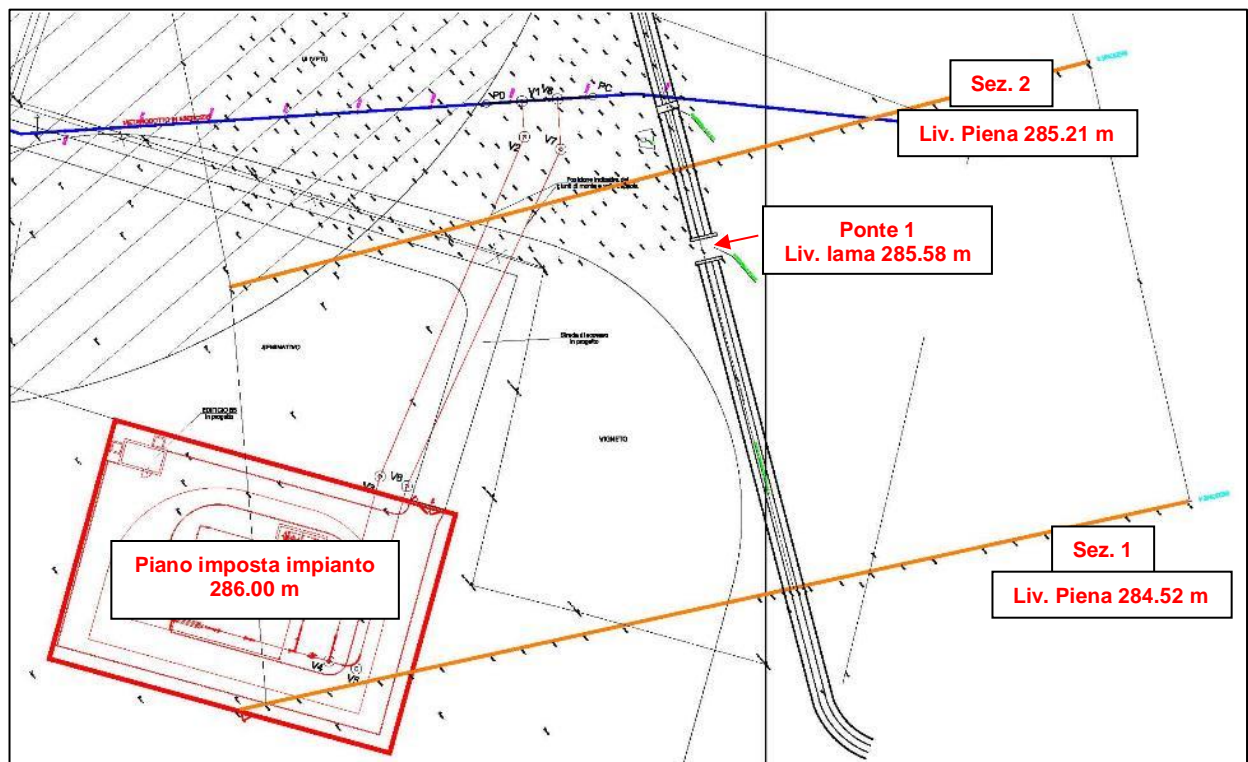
/B – Stralci planimetria di progetto con indicazione dei livelli idrici di piena
